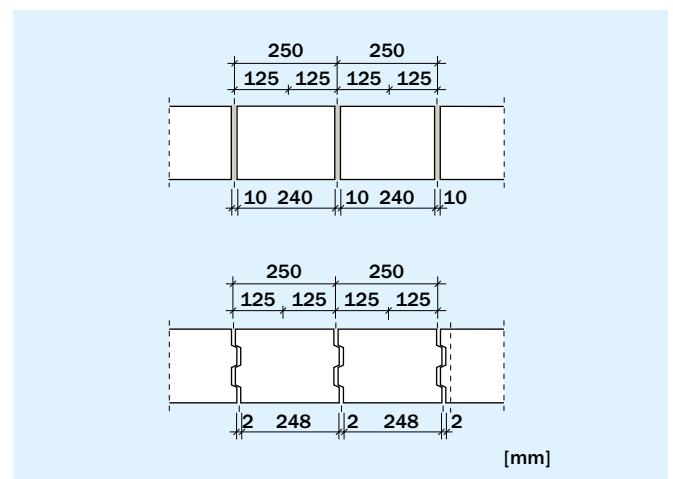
Baurichtmaße von Mauerwerk mit und ohne Stoßfugenvermörtelung
